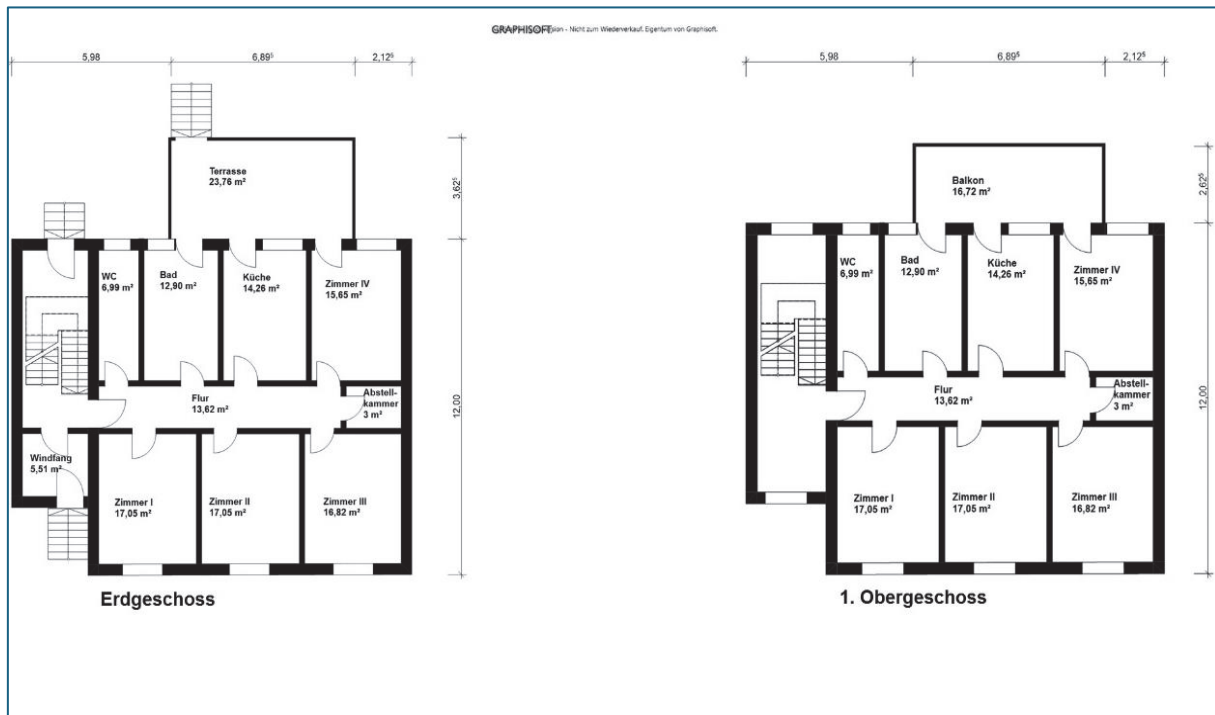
Grundriss der Einspänner mit Vierzimmerwohnungen, Quelle: eigene, nichtmaßstäbliche Darstellung in Anlehnung der Grundrisse der Einspänner in der Bachelor Arbeit „Lasst und Häuser bauen“ von Eyhorn (2024)
